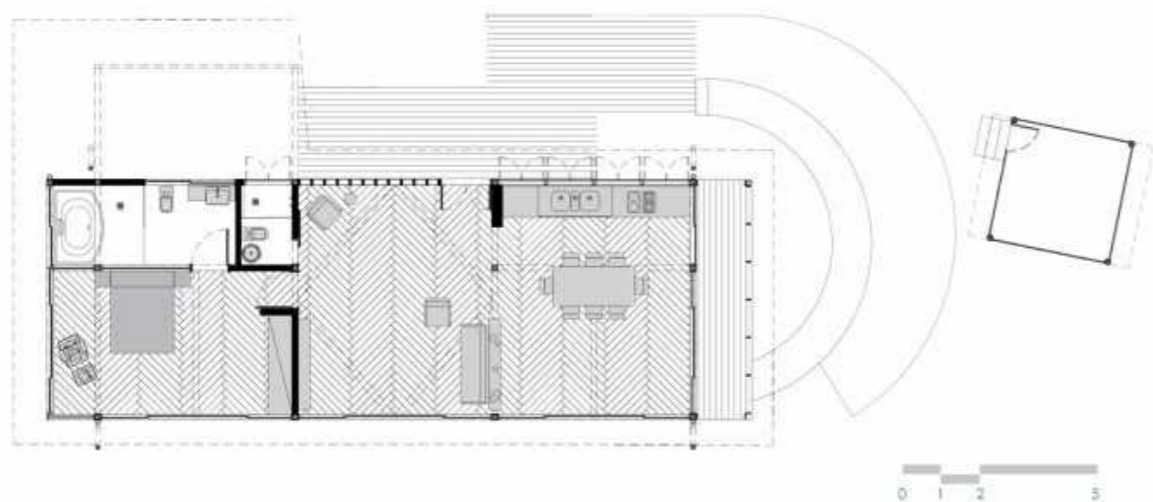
Planta pavimento térreo. Fonte: SustentArqui.
